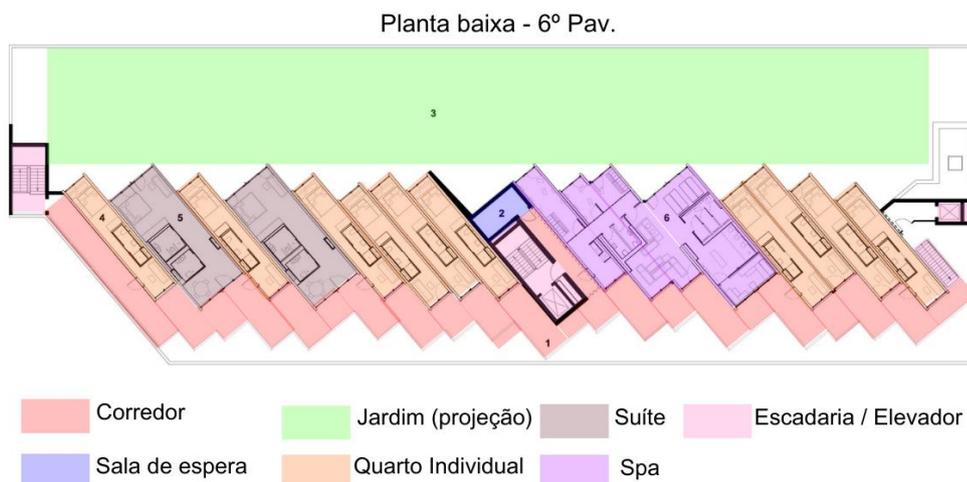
Setorização / Planta baixa 6º Pav. Alterado pelo autor.
